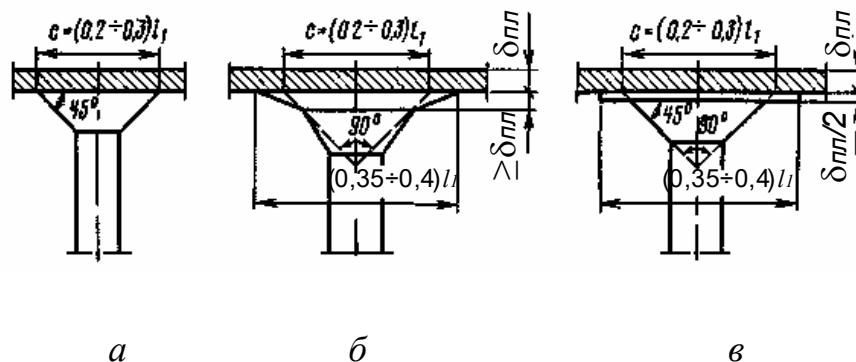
Типи капітелей монолітних безбалкових перекриттів:
